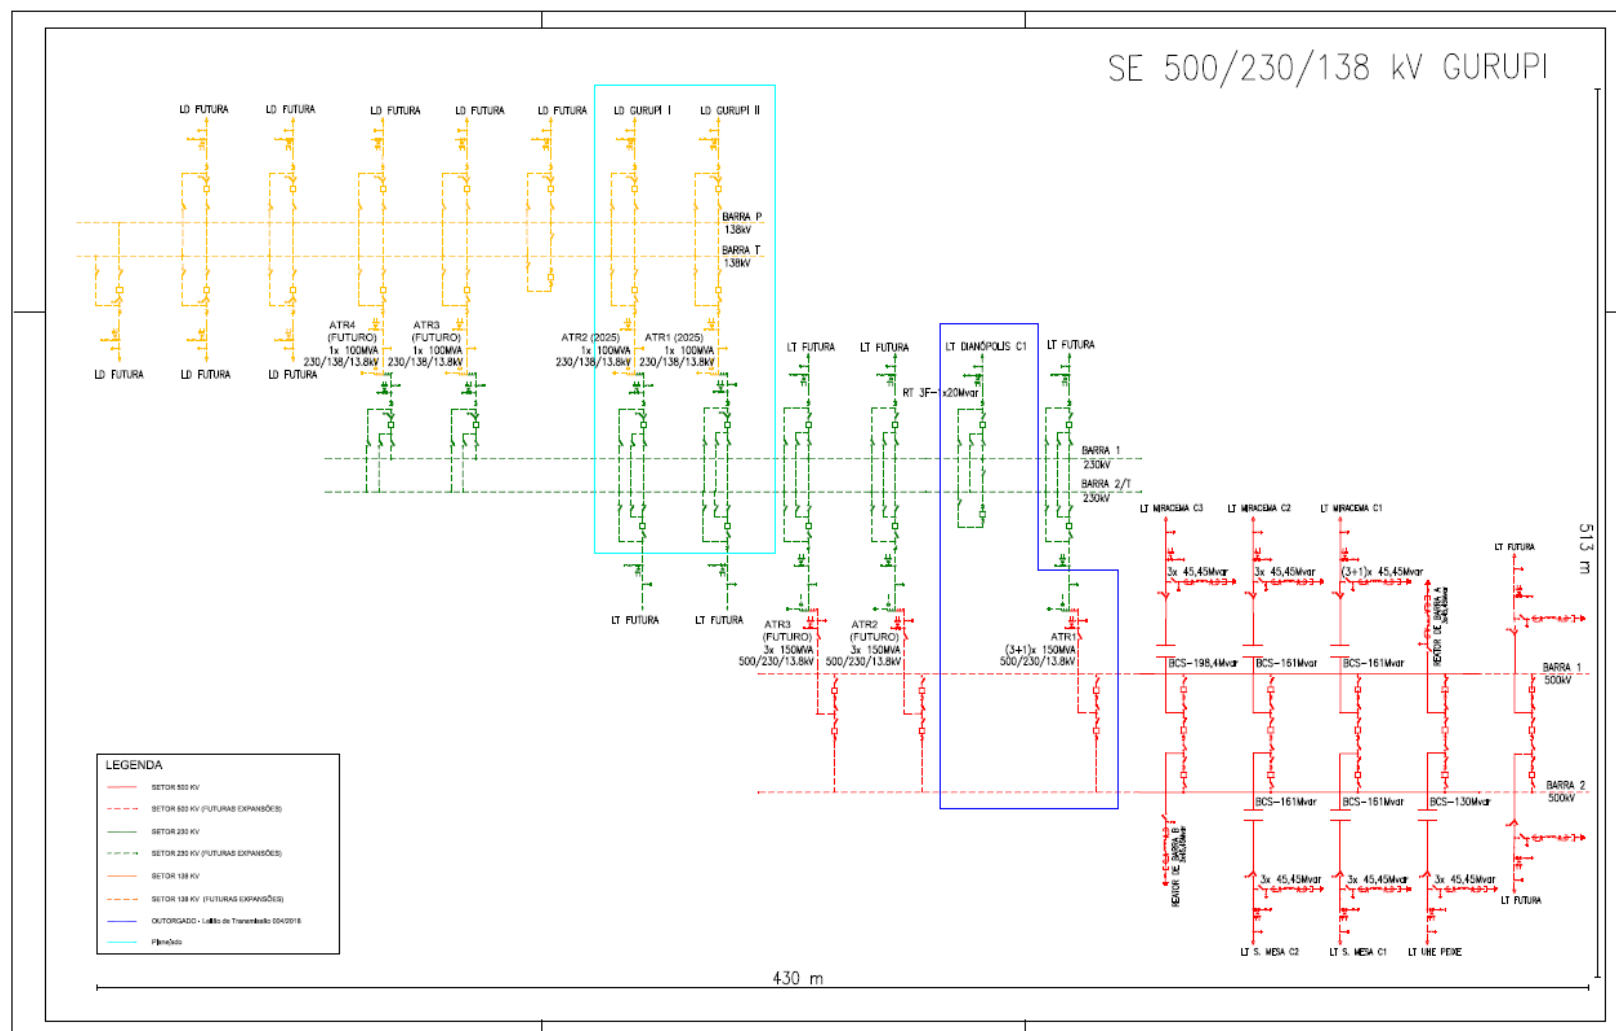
Arranjo Expansão da Subestação Gurupi 138 kV
